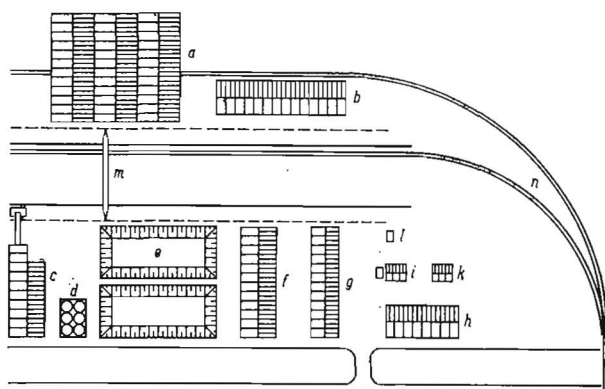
Landwirtschaftliches Zentrum (ZGE) Güterglück, Lageplan.
